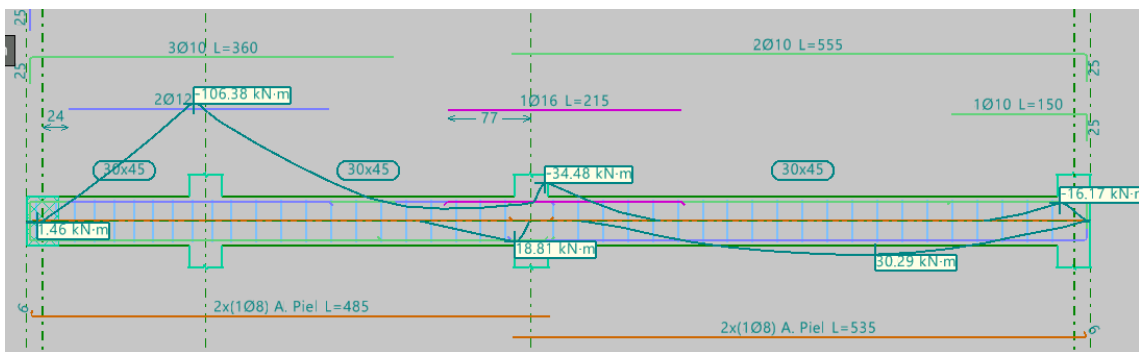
Viga T2 R2 N2 sin soporte de forjado en T2
